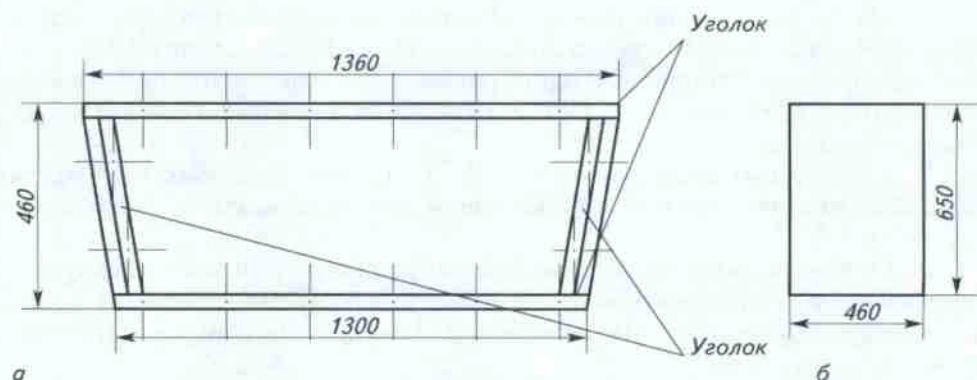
Конструкционные детали теплицы: а — плита-перекрытие,
